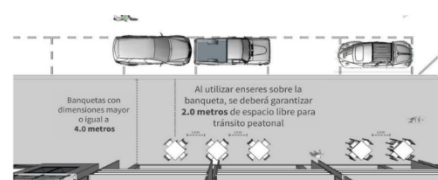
Colocación de enseres en banquetas con un ancho igual o mayor a 4.0 metros
